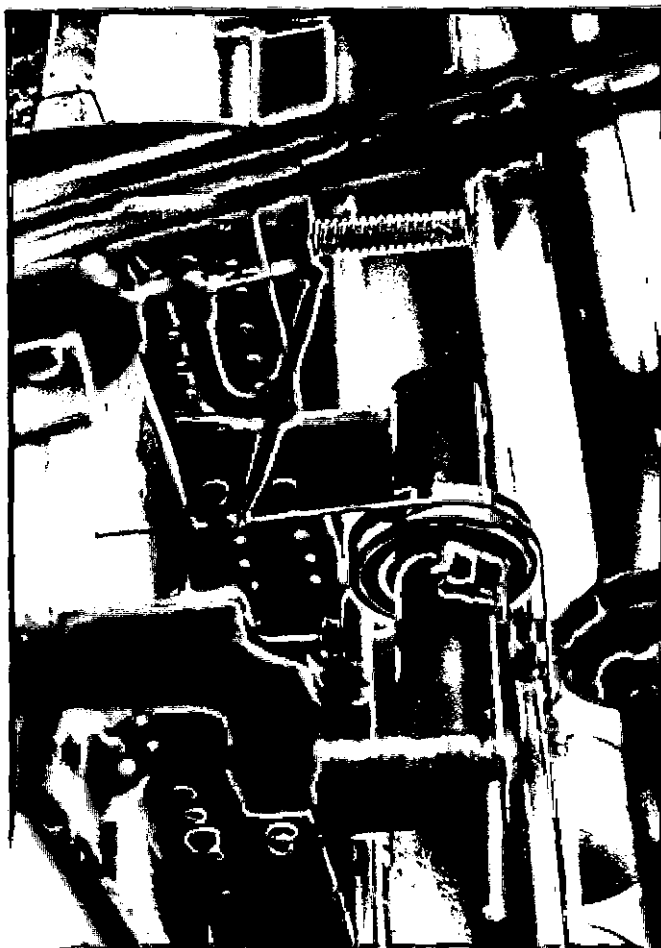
Detalhe do equipamento para arrancamento de ancoragem isolada.
